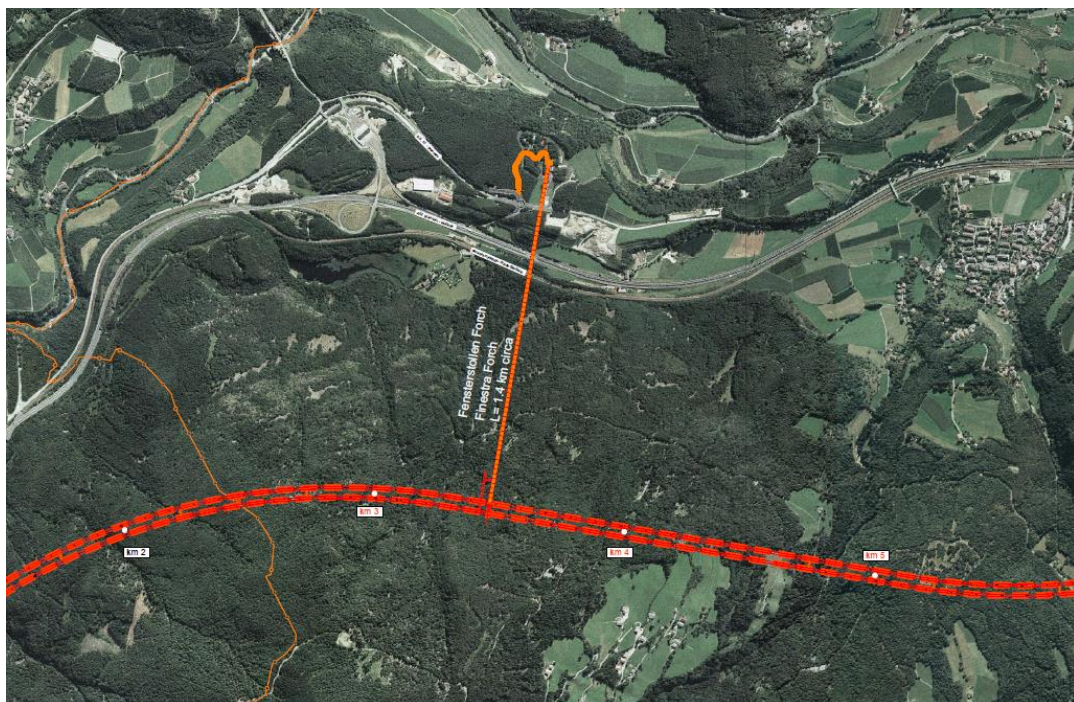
Finestra Forch –Stralcio planimetria di inquadramento
